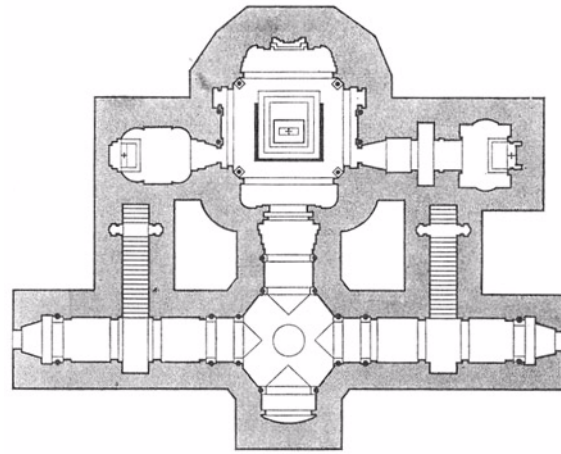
Grundriss der Unterkirche von SS. Martina e Luca.
